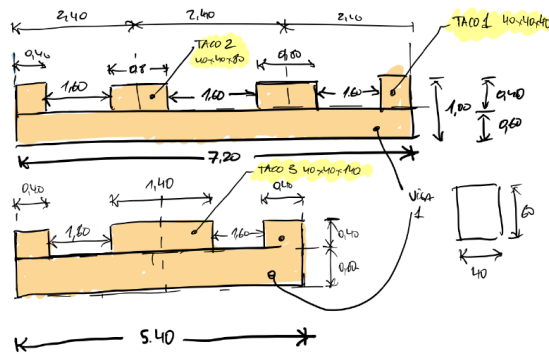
Geometría de "vigas peine". Fuente: Elaboración propia
